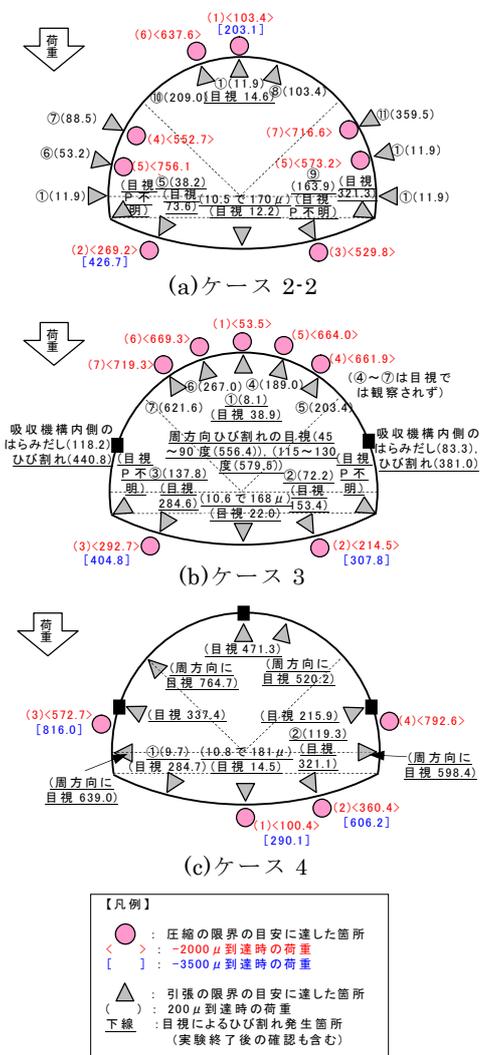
ひび割れ等の発生状況(鉛直方向荷重)
